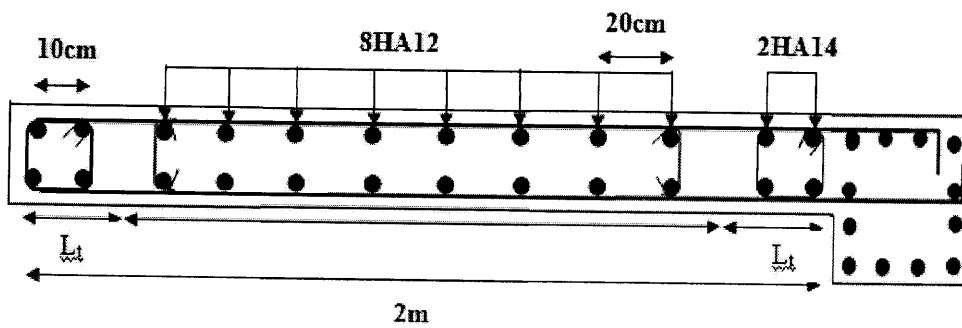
Schéma de ferrailage de voile longitudinal V4.
